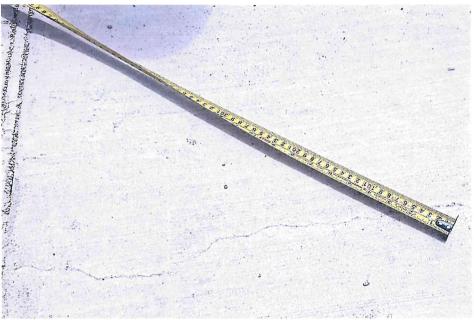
Fisuras en pavimento rígido de concreto fc=210 kg/cm2
